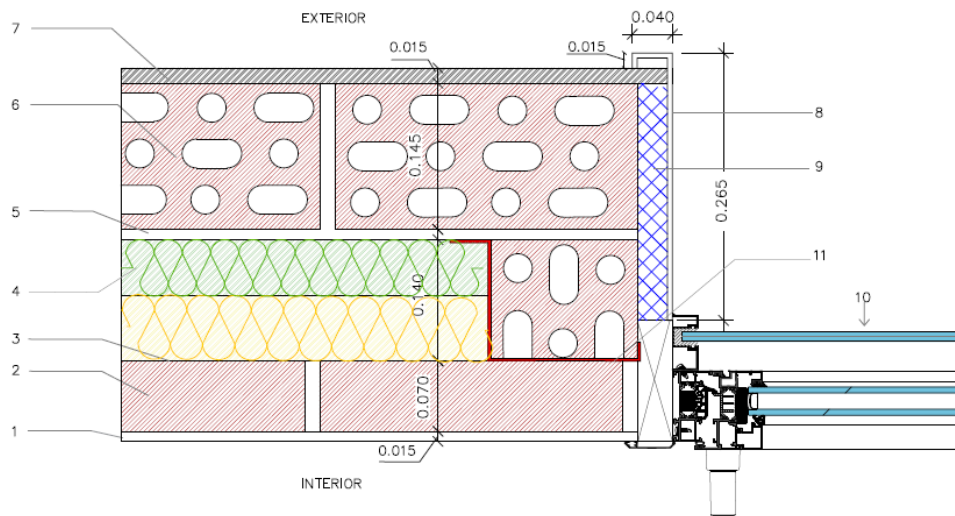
Sección constructiva, corte horizontal, de la propuesta de fachada tradicional a estudio.
